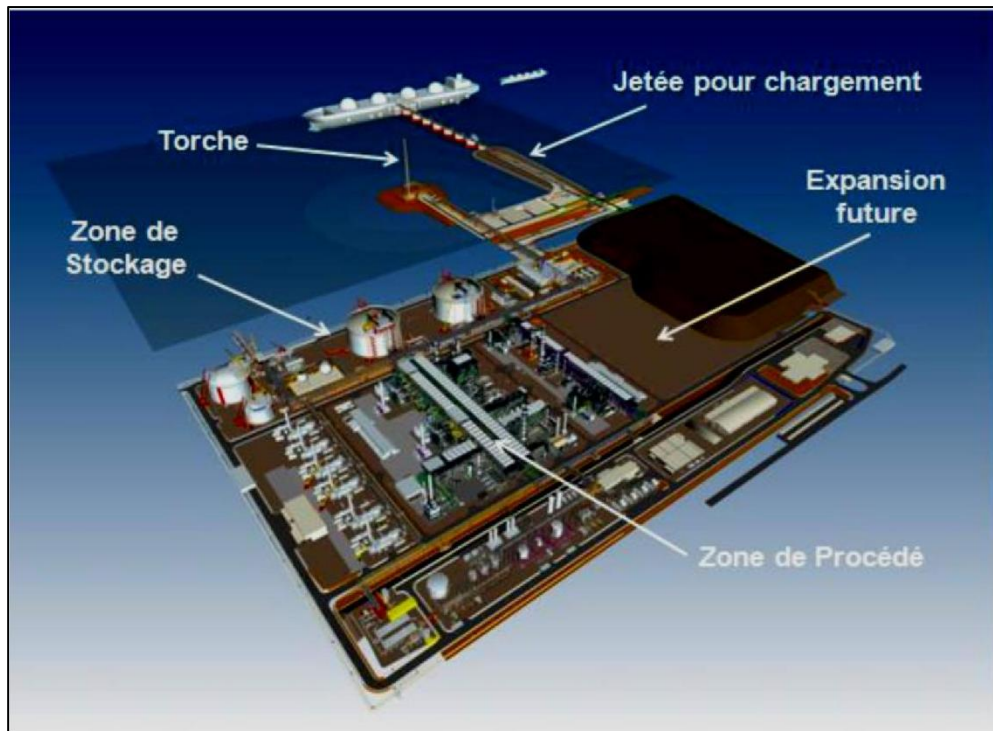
Maquette 3D vue d'ensemble de l'usine [11].
